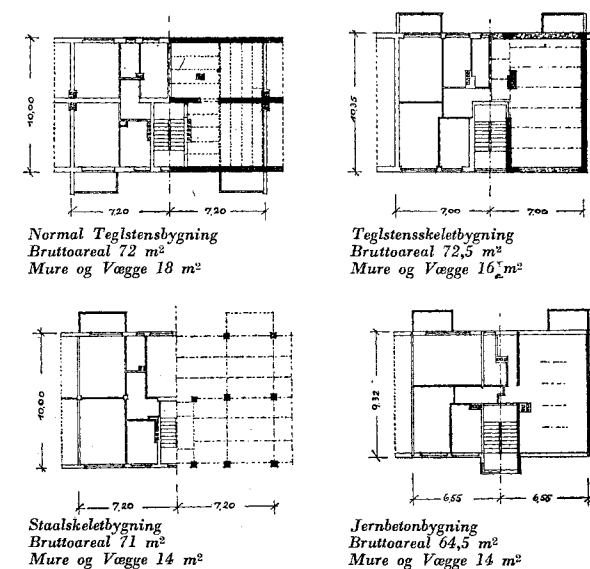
Sammenligning mellem tilsvarende Planer i forskellige Konstruktioner.
